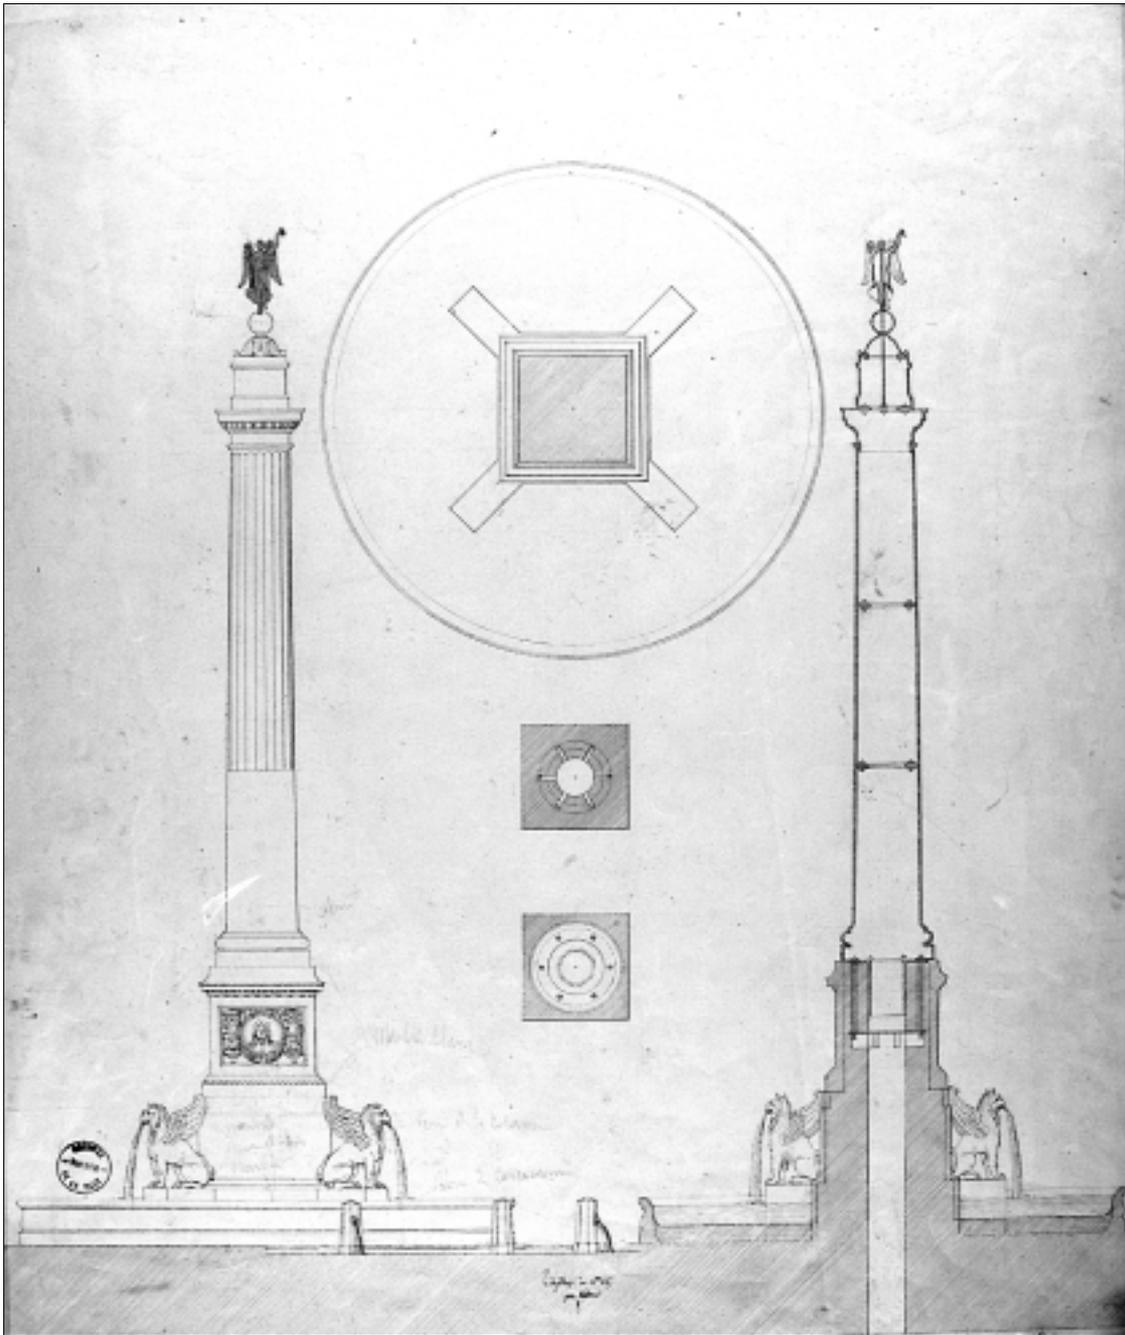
ÉLÉVATION, PLAN ET COUPE DE LA COLONNE DUPUY, plume, U. Vitry, 1832 (A.M. Toulouse).
